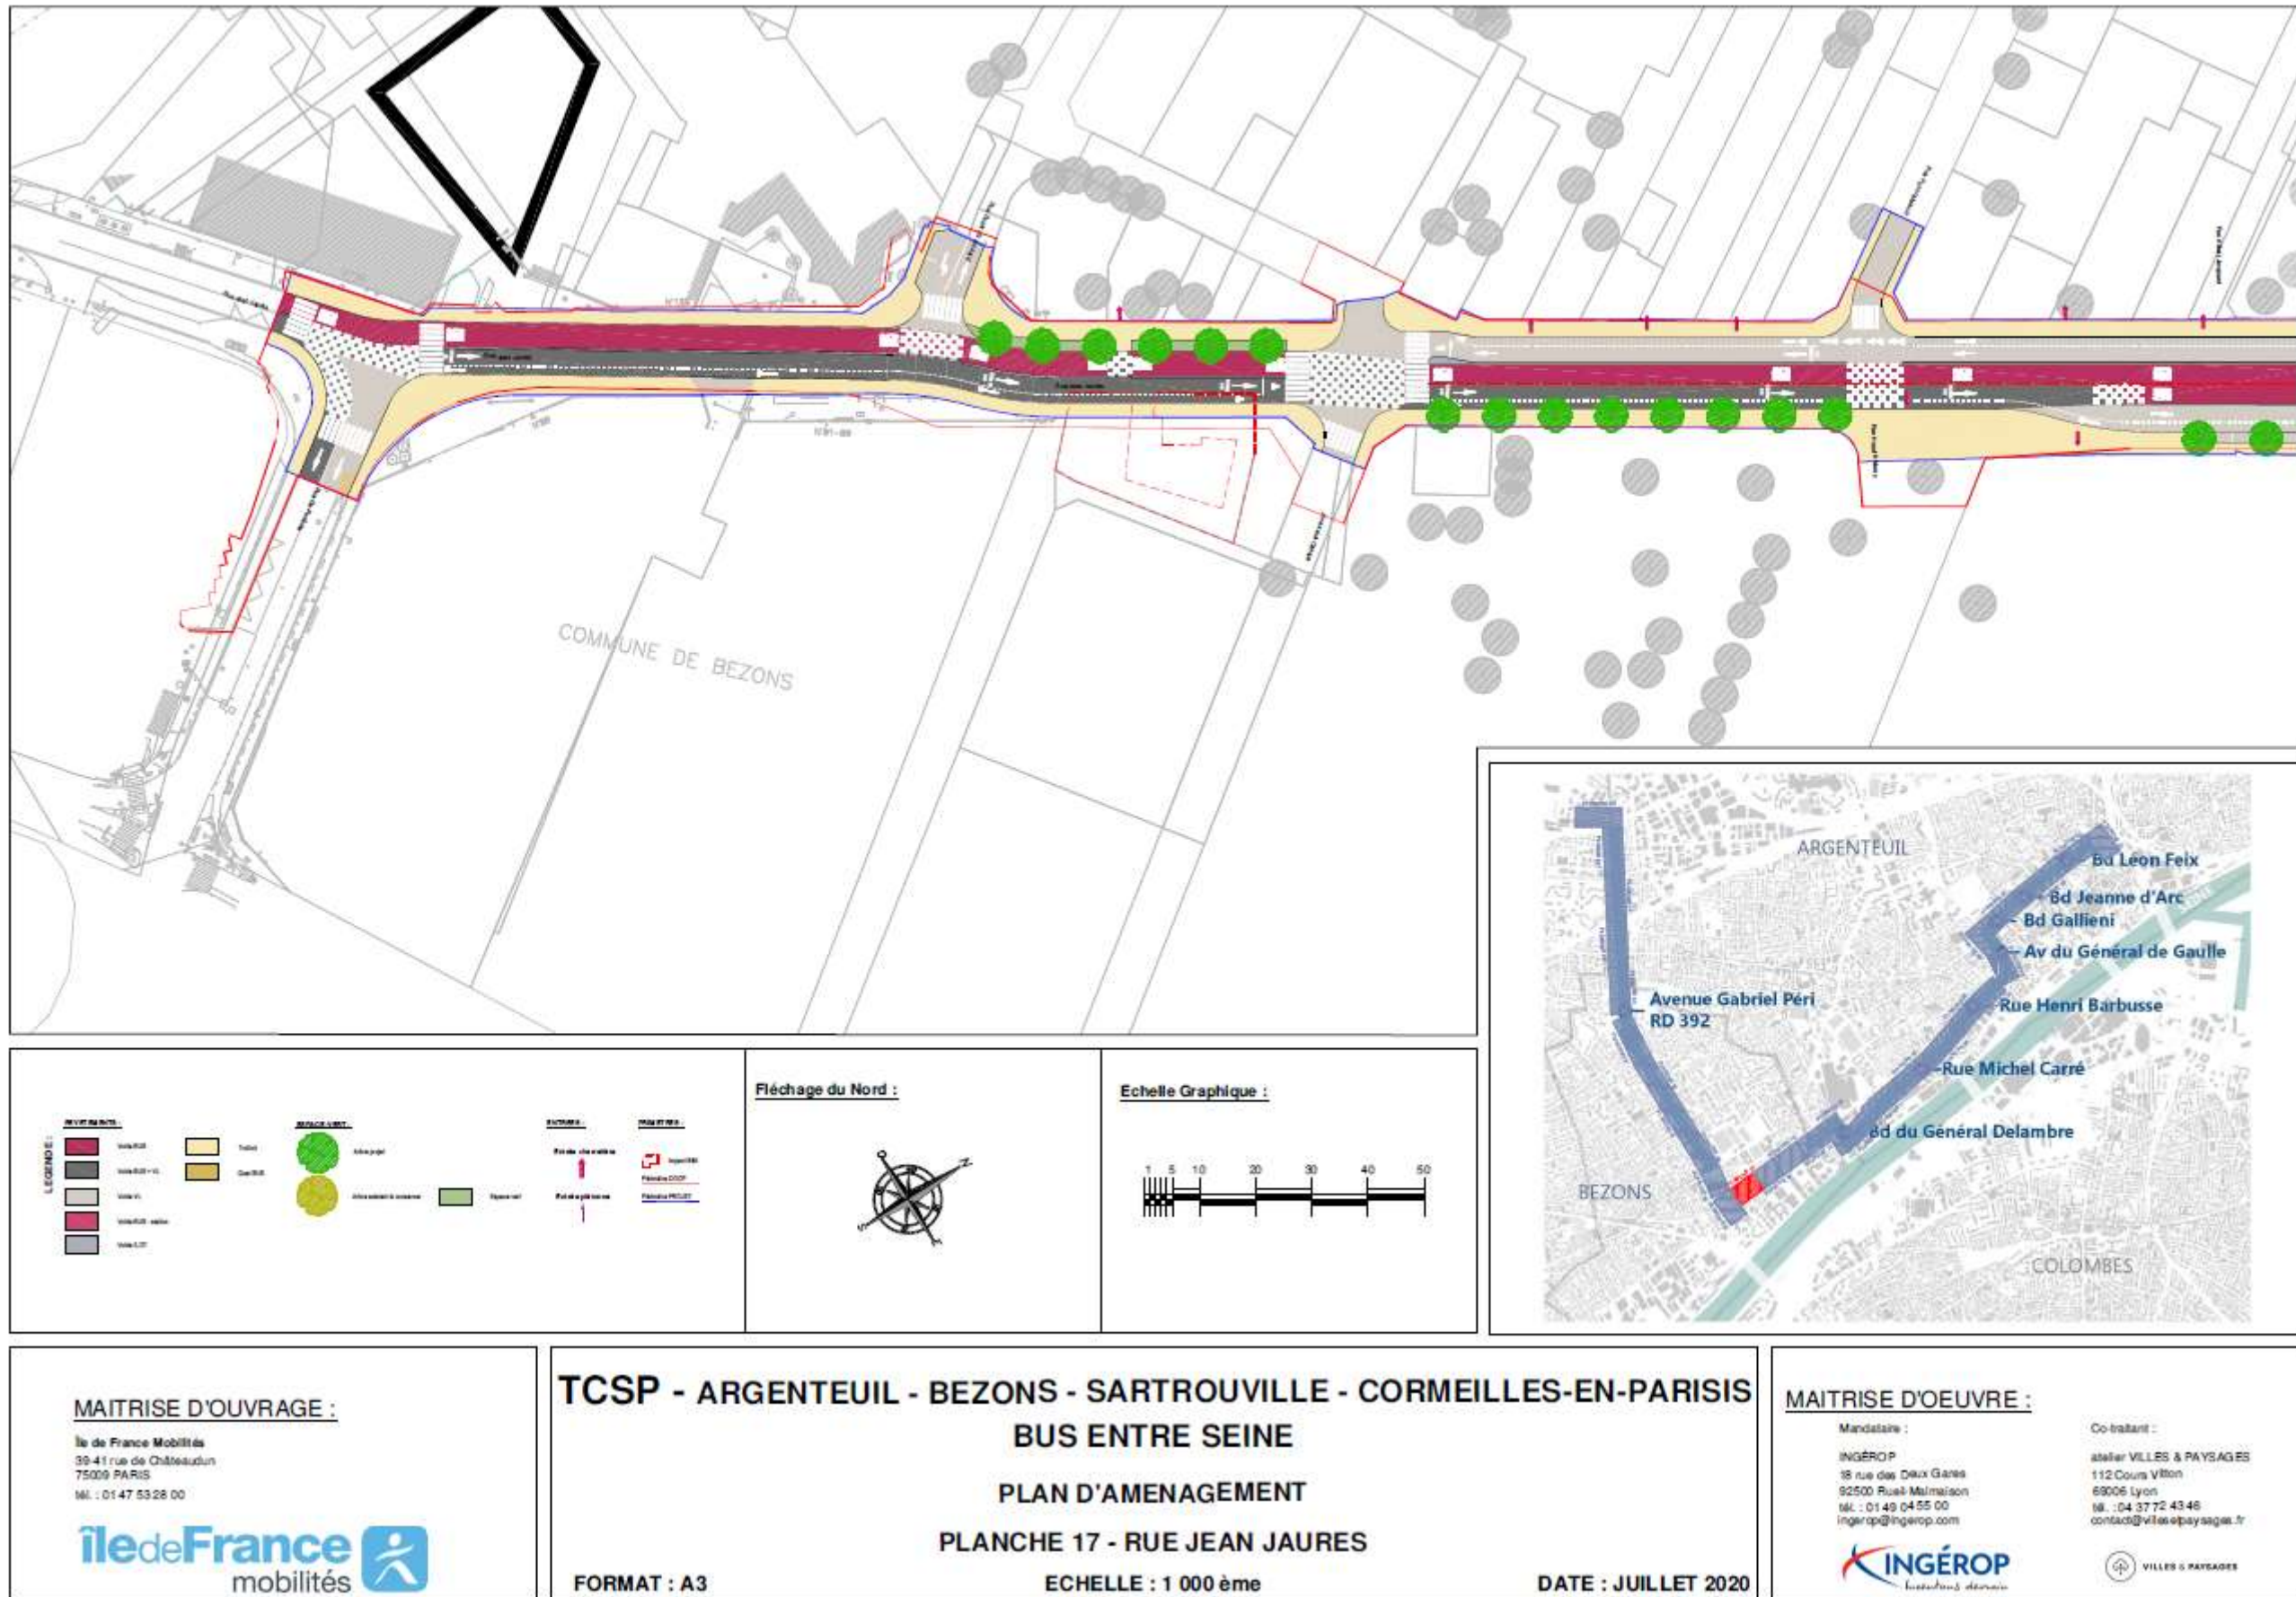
Plans d'insertion sur les rues Casanova et Jean Jaurès
